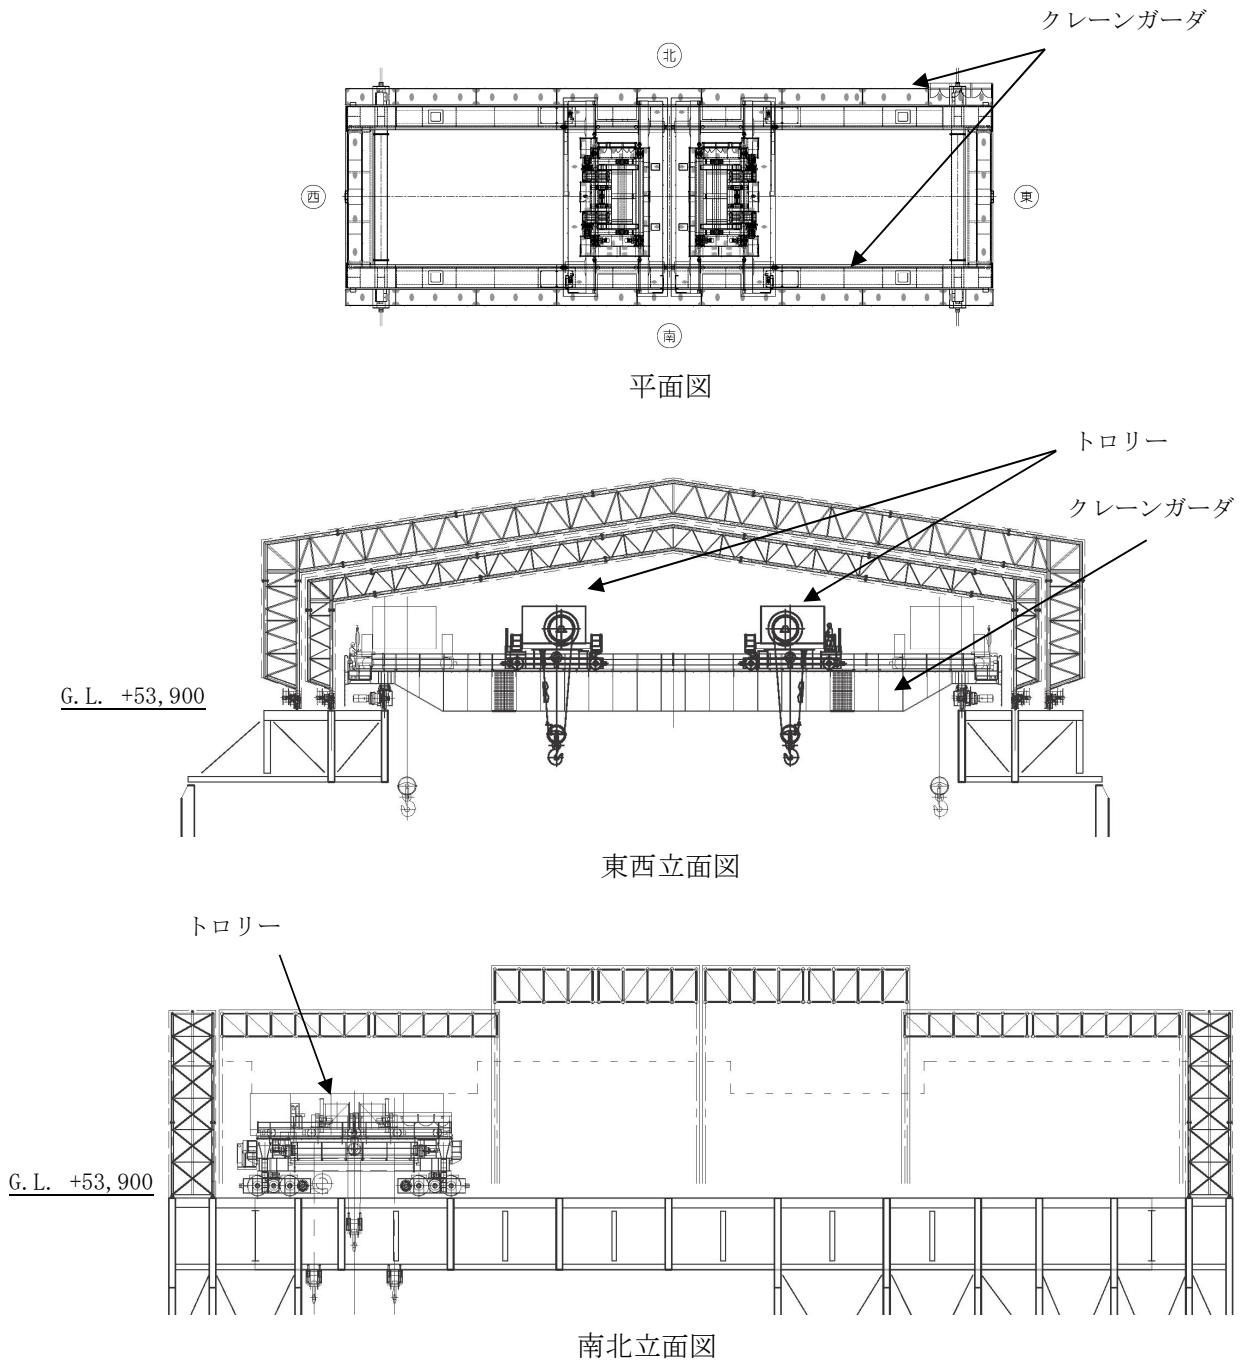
ガレキ撤去用天井クレーン概要図
